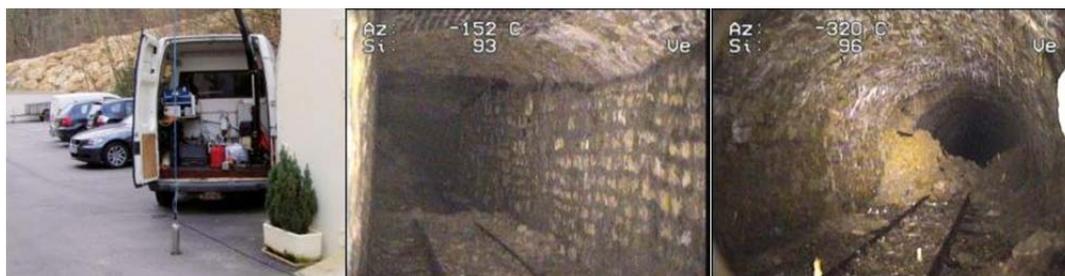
Inspection de la zone R325M1 à partir du forage 521 – Photographies de la cavité.
